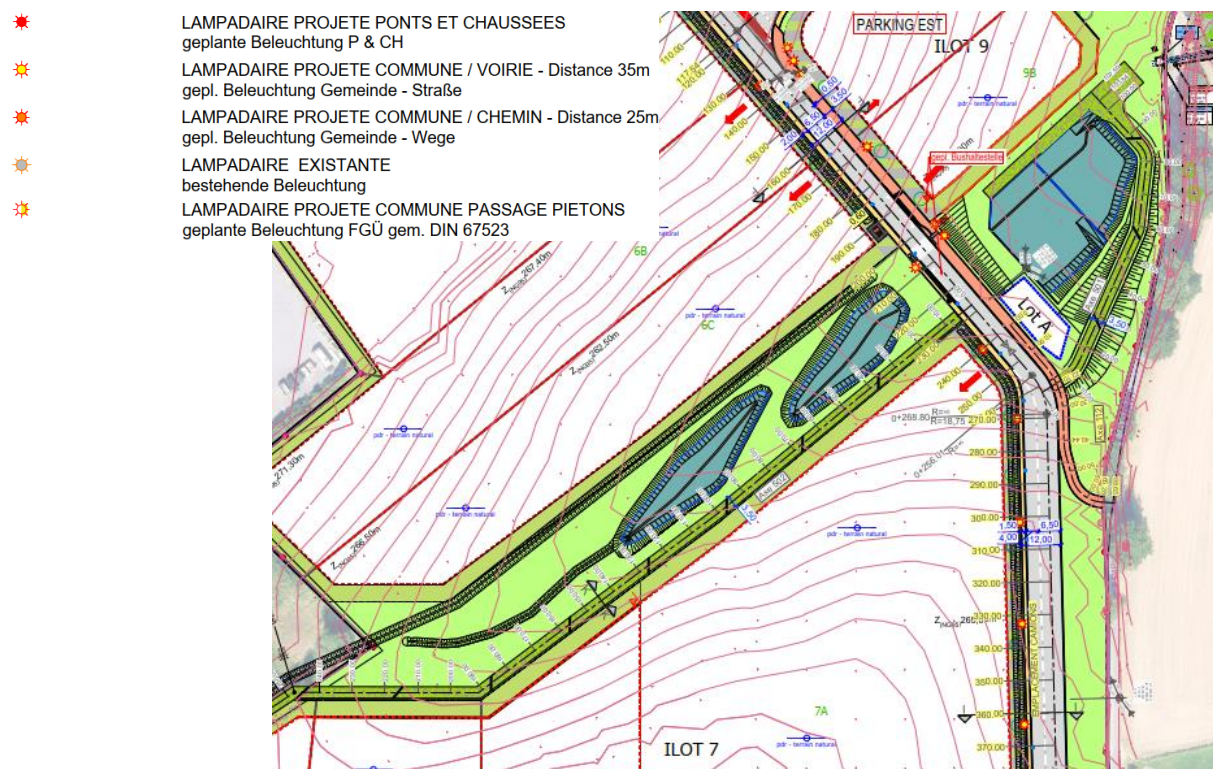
Darstellung der geplanten Beleuchtung im Bereich des zentralen Grünbandes mit Retentionsbecken (Quelle: BEST S.à r.l. 2024, Plan Plan 002001a). Größere Darstellung in Anhang 07a.
